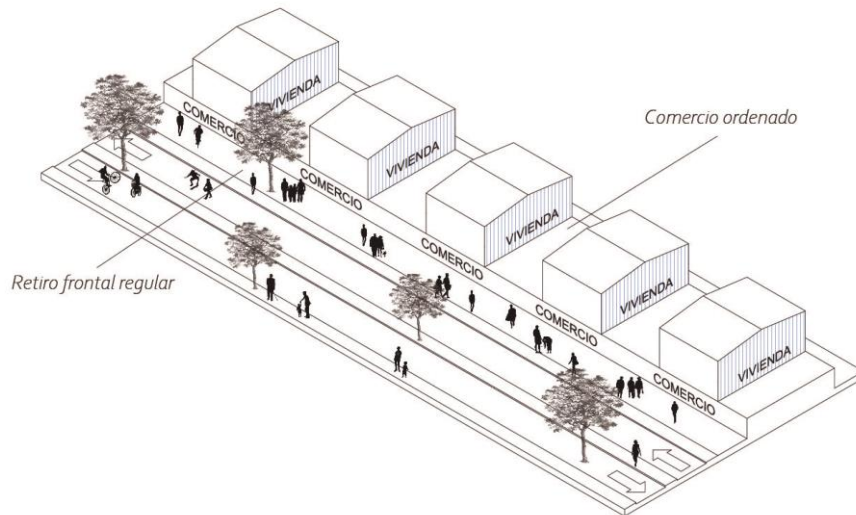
Propuesta para el barrio. Elaboración conjunta Taller 9
